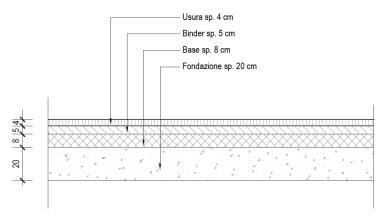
Dettaglio pacchetto di pavimentazione NV04
